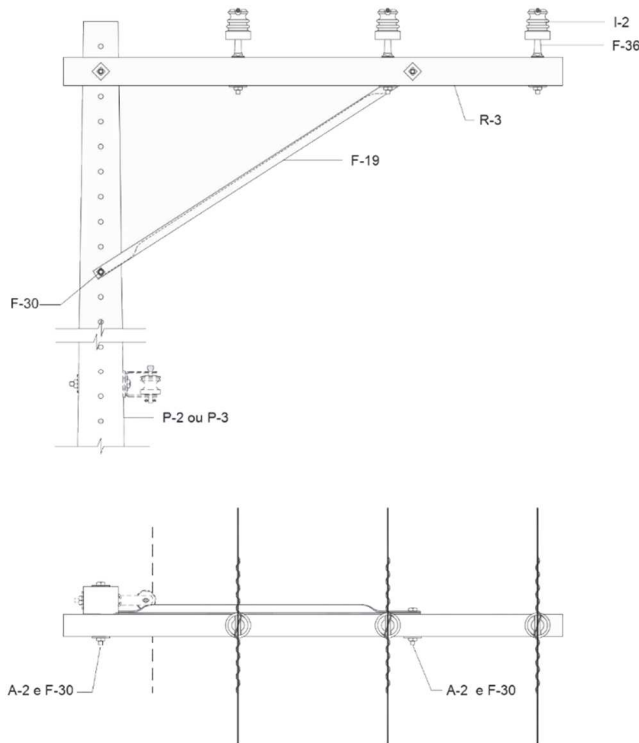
Primário – Estrutura B1 – Poste de concreto de seção circular
